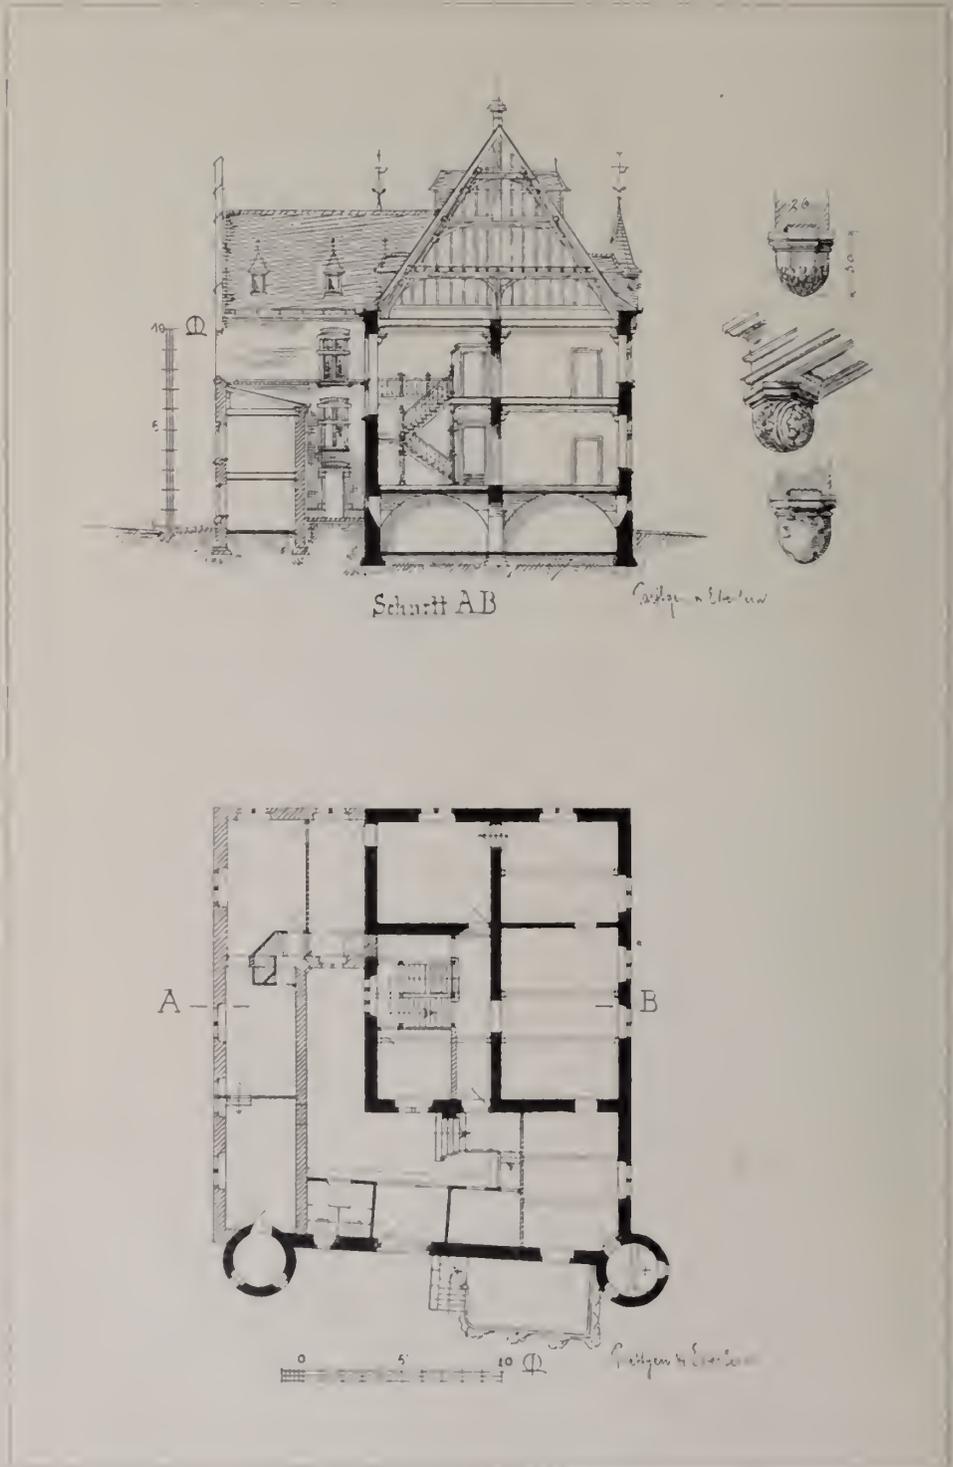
Haus Ingenhoven. Grundriss und Querschnitt
